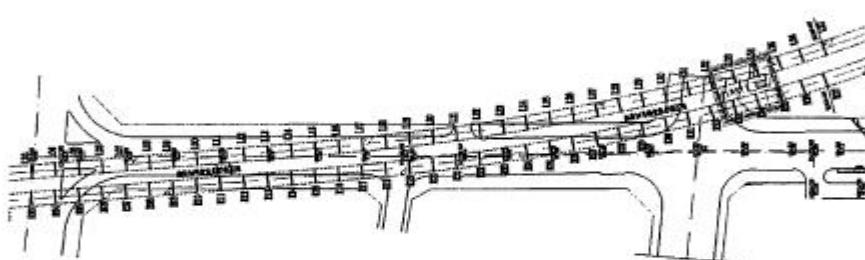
沙湖路市政工程与地铁线路位置关系平面图
